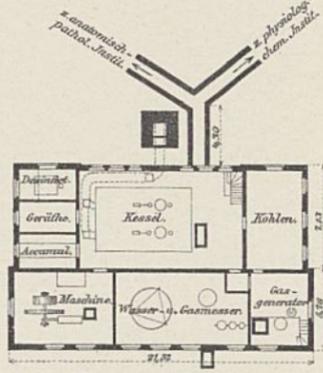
Kessel- und Maschinenhaus. Grundriss.
